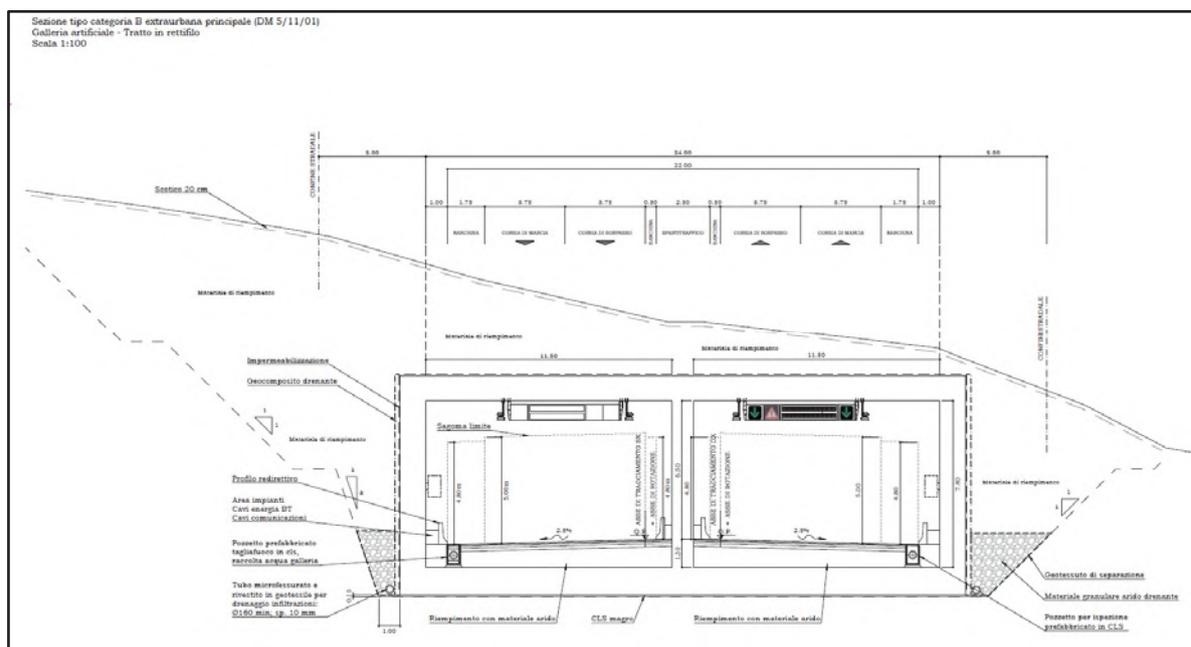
Sezione tipologica galleria artificiale ed elementi di arredo.
